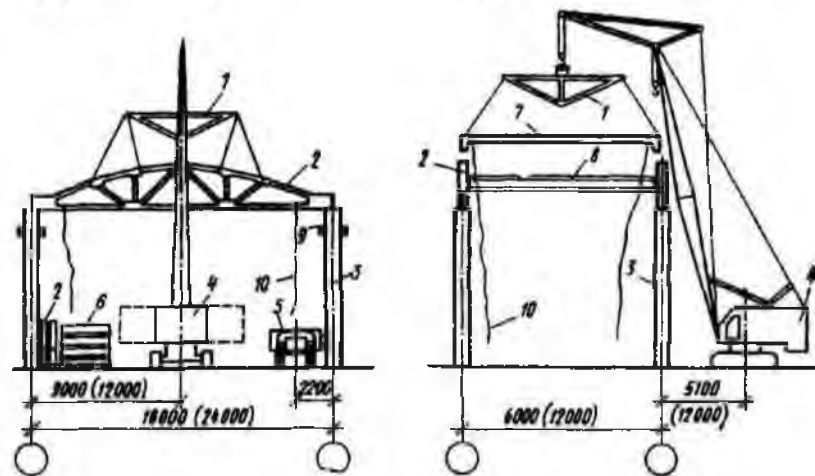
Схемы монтажа фермы пролетом 9, 12, 18 и 24 м и плиты покрытия продольным методом:
